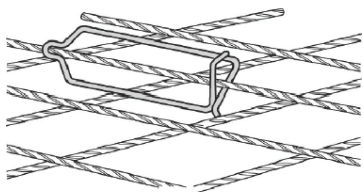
Einhängen wie dargestellt unter den oberen Bewehrungsstab.
